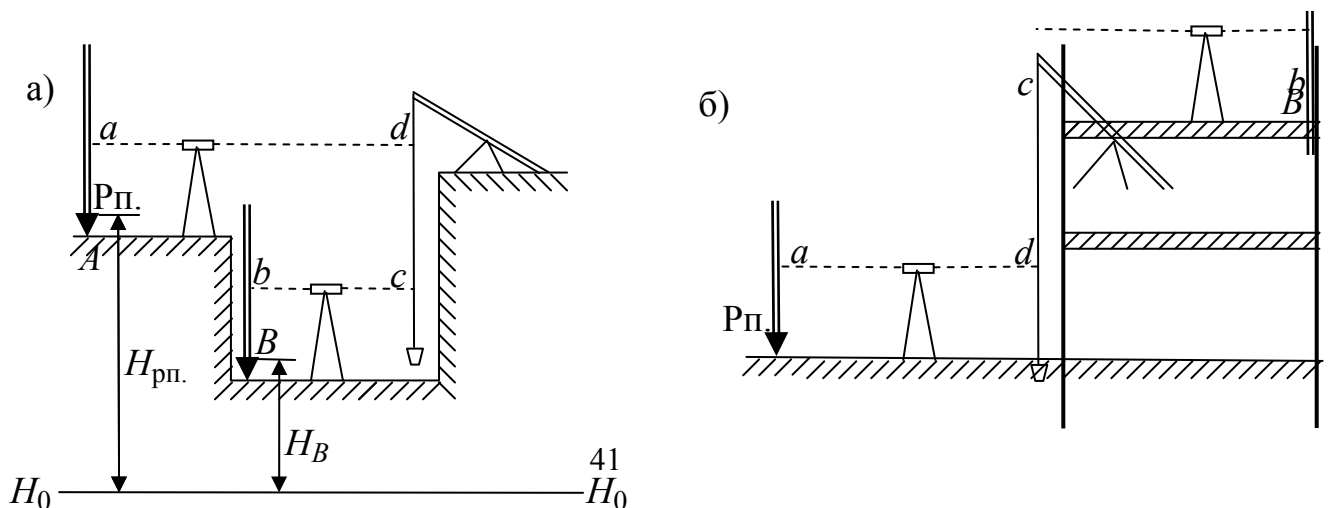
Передача отметки: а) – в котлован; б) – на монтажный горизонт
